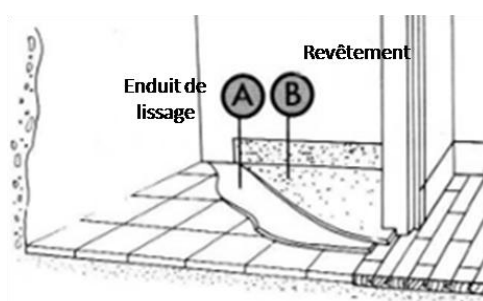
Collage d'un revêtement de sol sur carrelage existant
